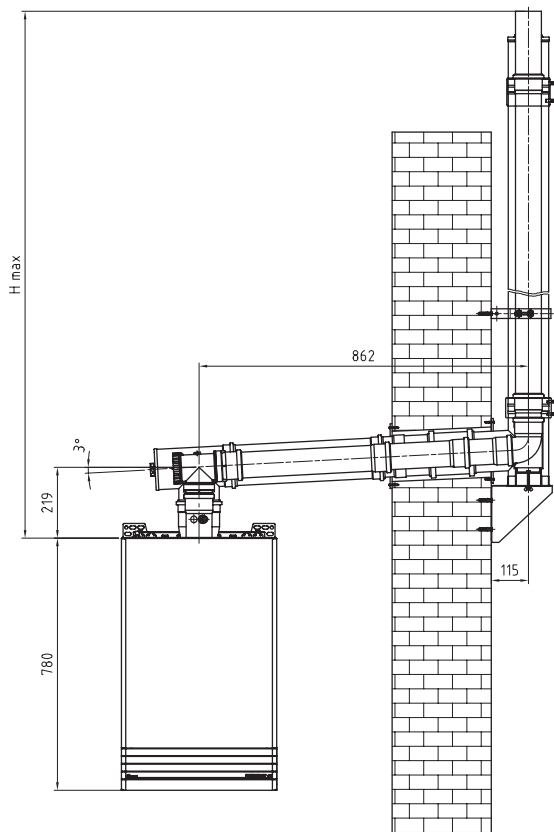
Rookgasafvoergeleiding onafhankelijk van de omgevingslucht in de schacht
